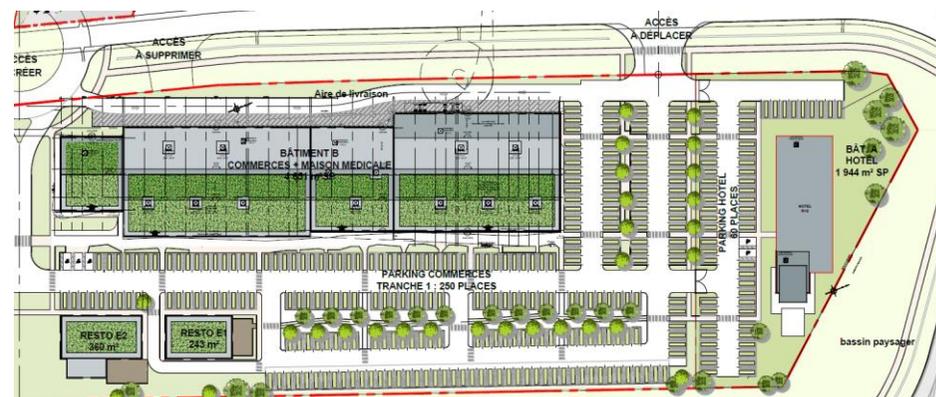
Plan de masse - phase 1 de la zone commerciale (Source : Artchimad, Avril 2022)
